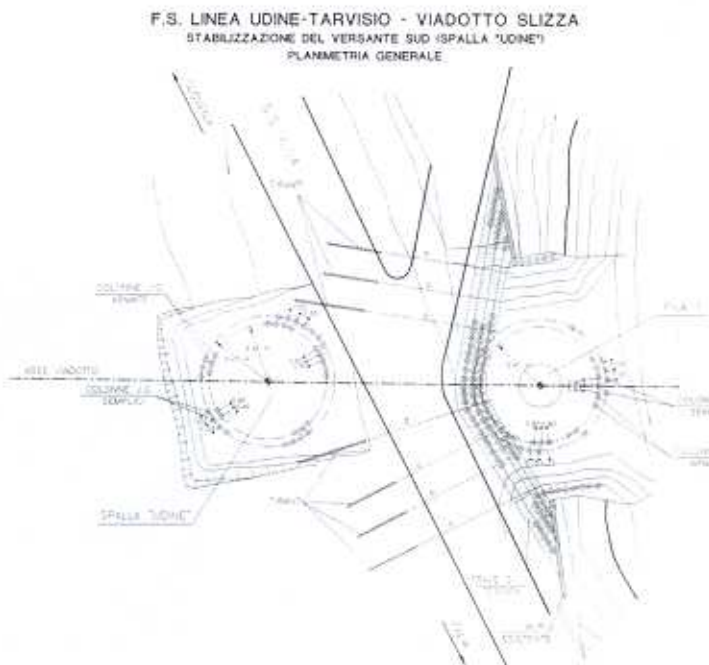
Schema planimetrico degli interventi a protezione della S.S. 54 presso la pila 1
